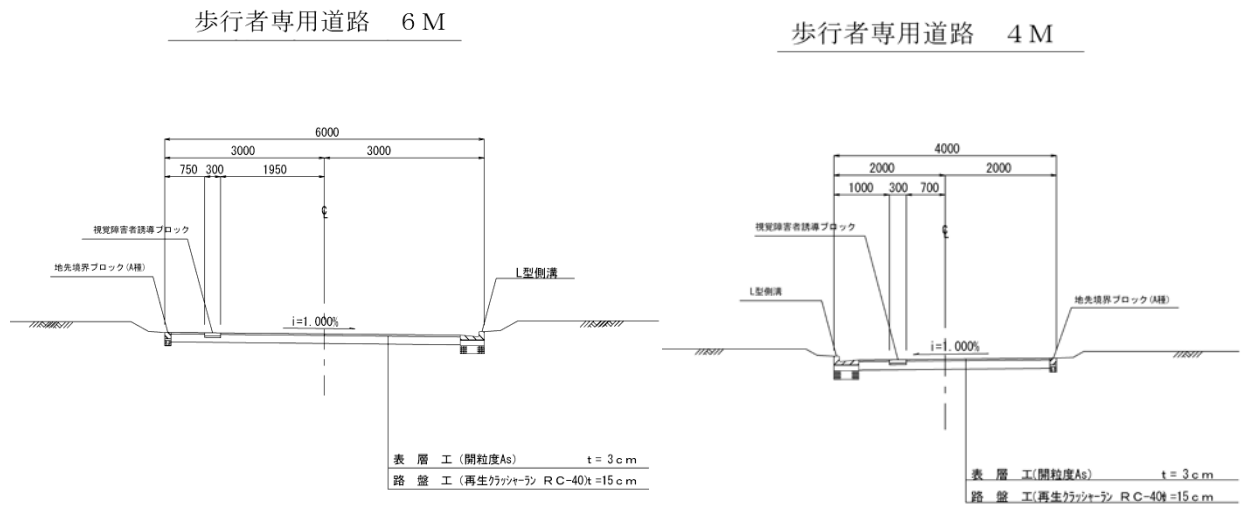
(7) 道路断面図(歩行者専用道路標準断面)
